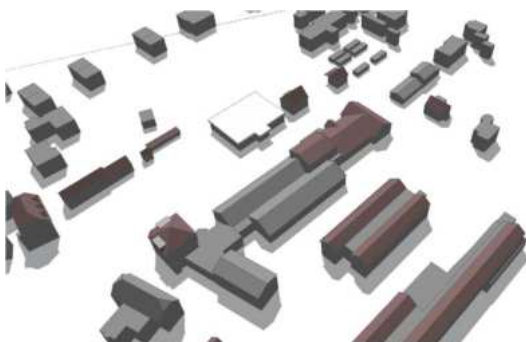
Baumassenstudie Ansicht Nord-Ost Bestand
